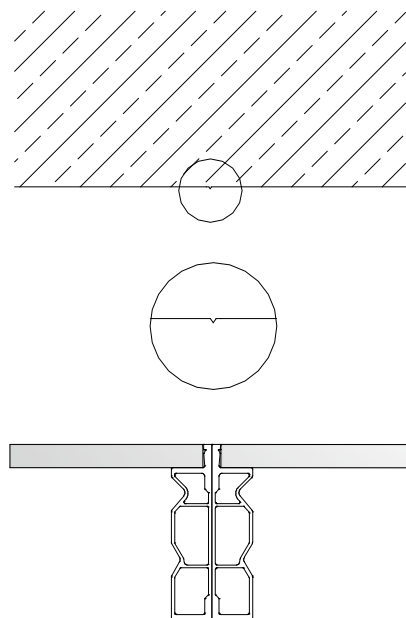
Rahmenprofil mit alkus-Platte – ebenere Betonierfläche, da keine überstehenden Profilenasen.
